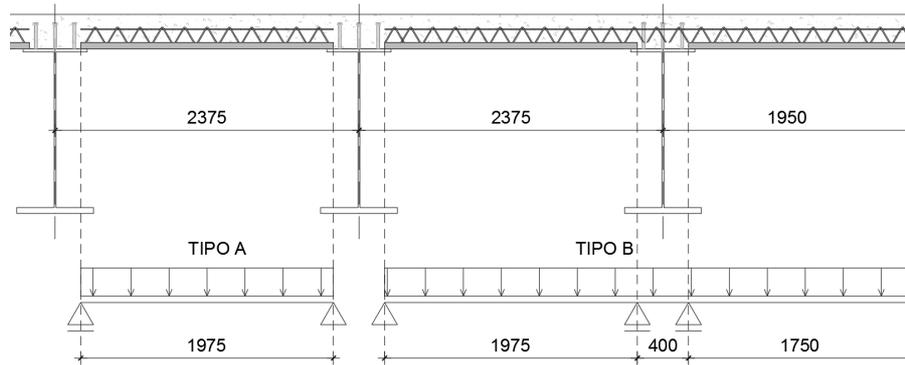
Sezione trasversale tipologica: disposizione delle lastre predalles.
